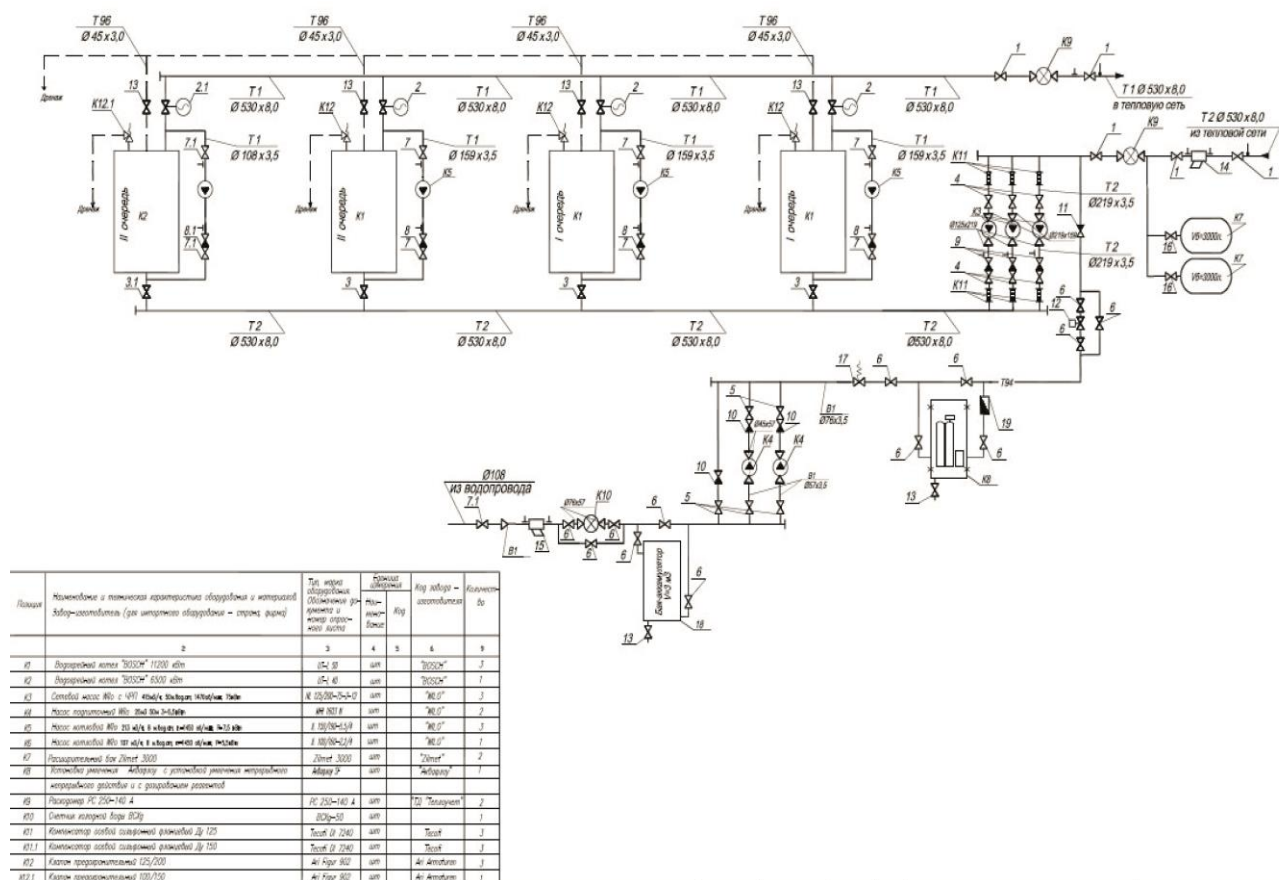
Схема котельной ЖК "Усадьба Царево"
